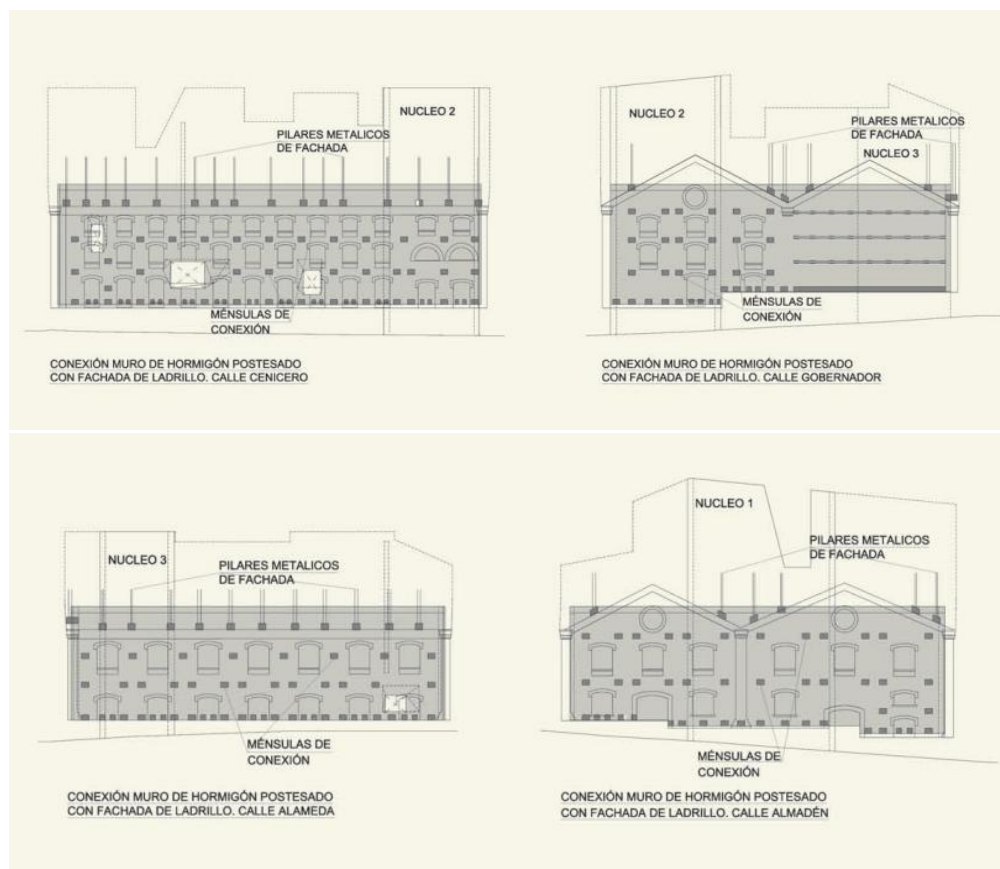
Conexión muros de fachada conservado y muro postesado de la nueva estructura de Caixa Fòrum en Madrid (Jiménez Cañas & Bernabeu Larena, Caixaforum Madrid, 2008).
